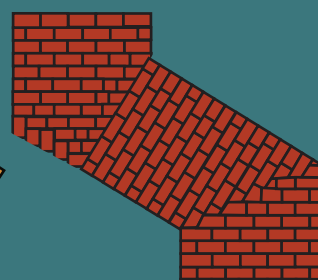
Esquina en ángulo obtuso. Encaje alternante.
